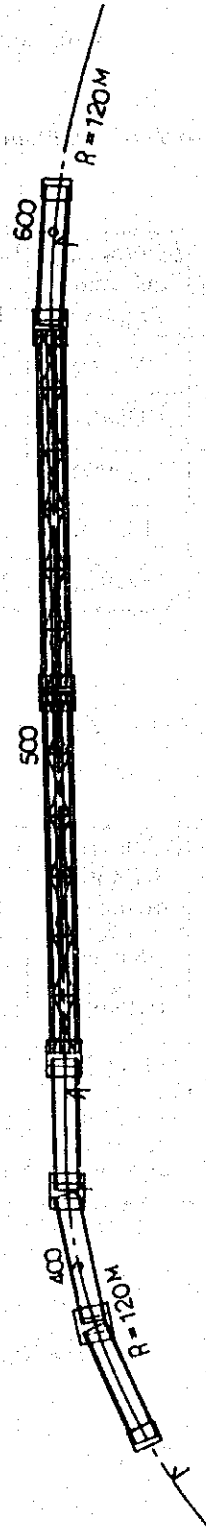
Plano General del Puente del RIO CHANGOLLA
